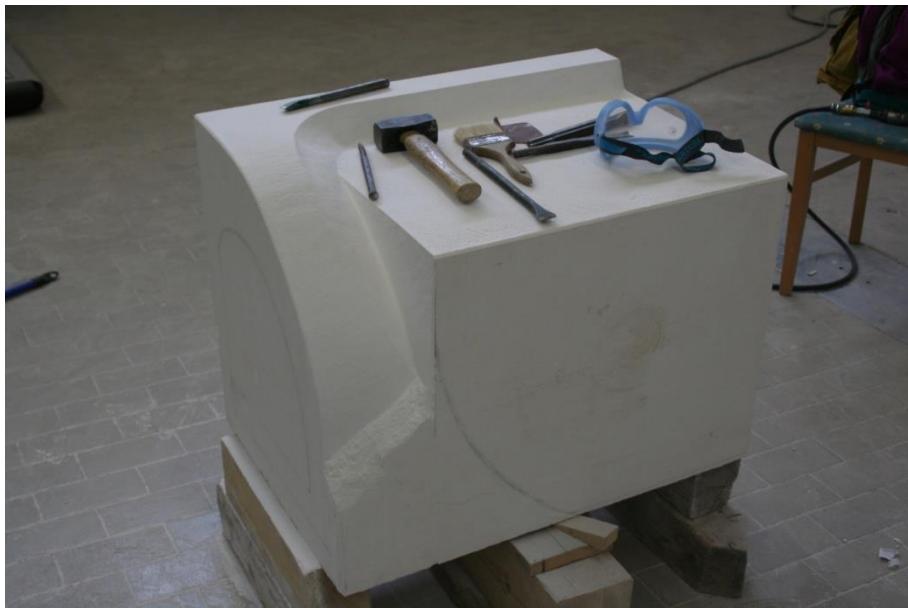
Zapilavanje prijelaza između prve i druge strane kamenog bloka, fotografija: Josipa Krolo
